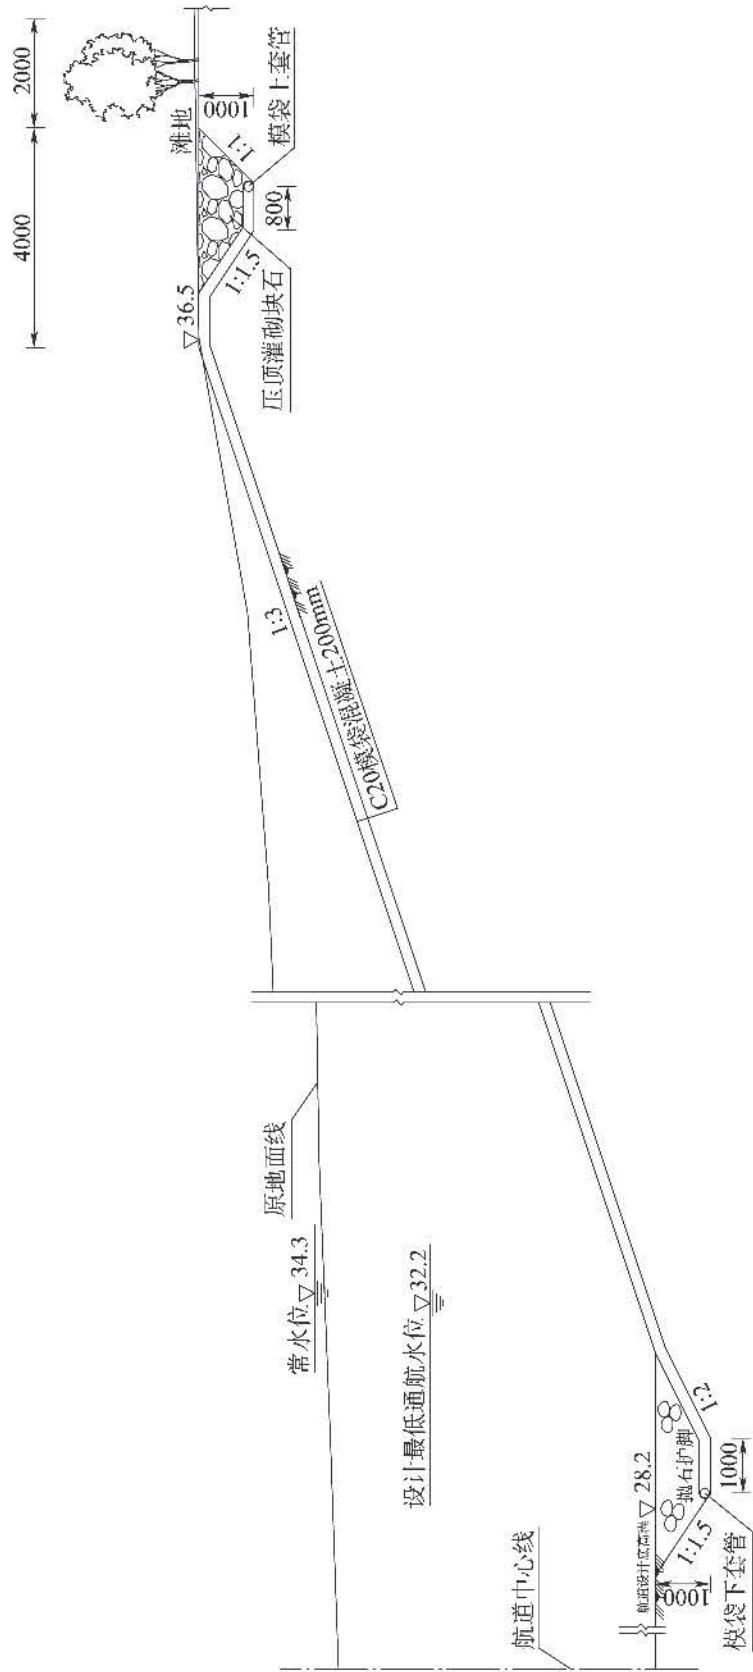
航道整治工程-华东某运河航道整治工程-1#护岸断面示意图(尺寸单位:mm;高程单位:m)
